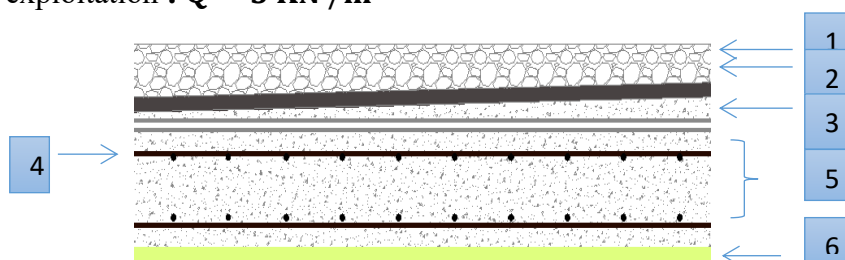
Composants d'un plancher terrasse en dalle pleine.
